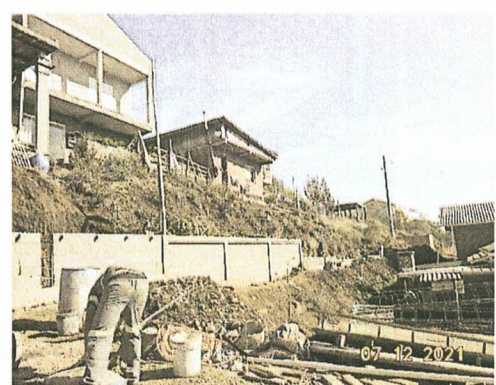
e 18 – Execução Pavimentação e Passeio Público
